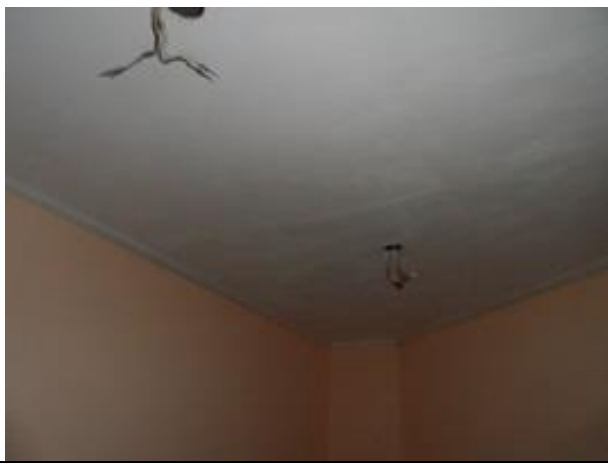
Часть помещения №7 помещения 6-Н, потолок
